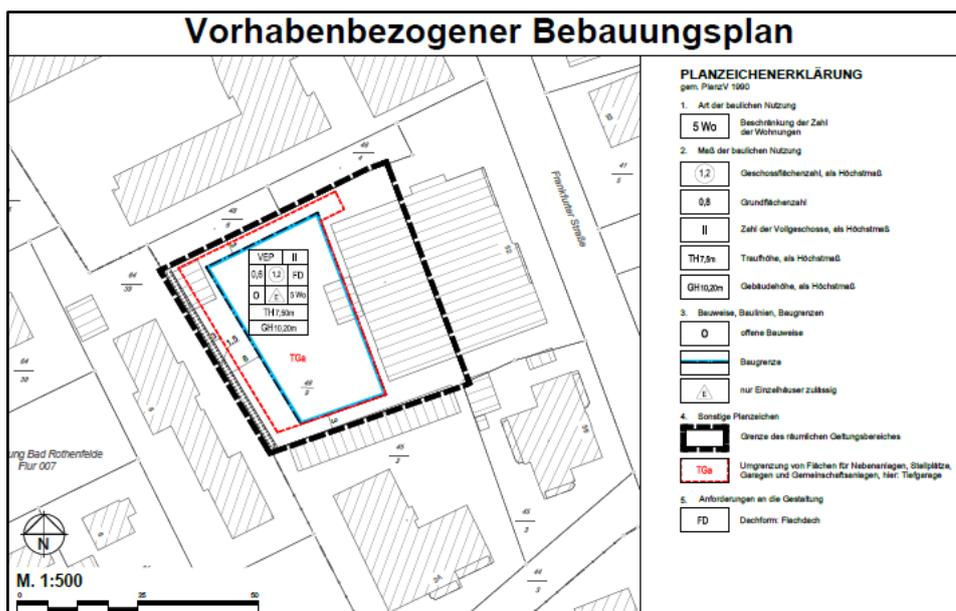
Ausschnitt aus dem Bebauungsplan Nr. 66 -Teil A, (Entwurf) genordet, ohne Maßstab
